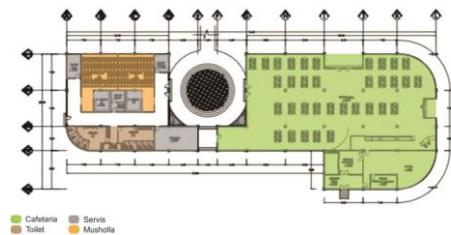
Denah Lantai Satu Hasil Pengembangan Desain, 2015
